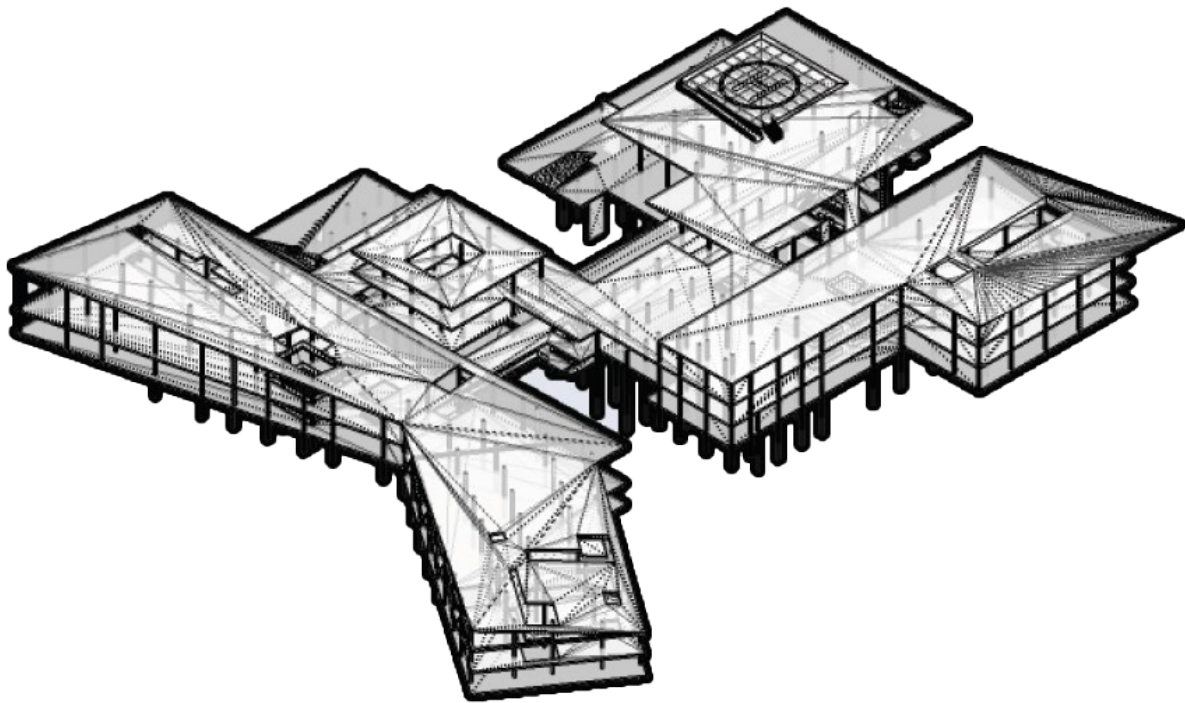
Estructura. Nota: Axonometría estructural. Elaboración propia: Sketchup
